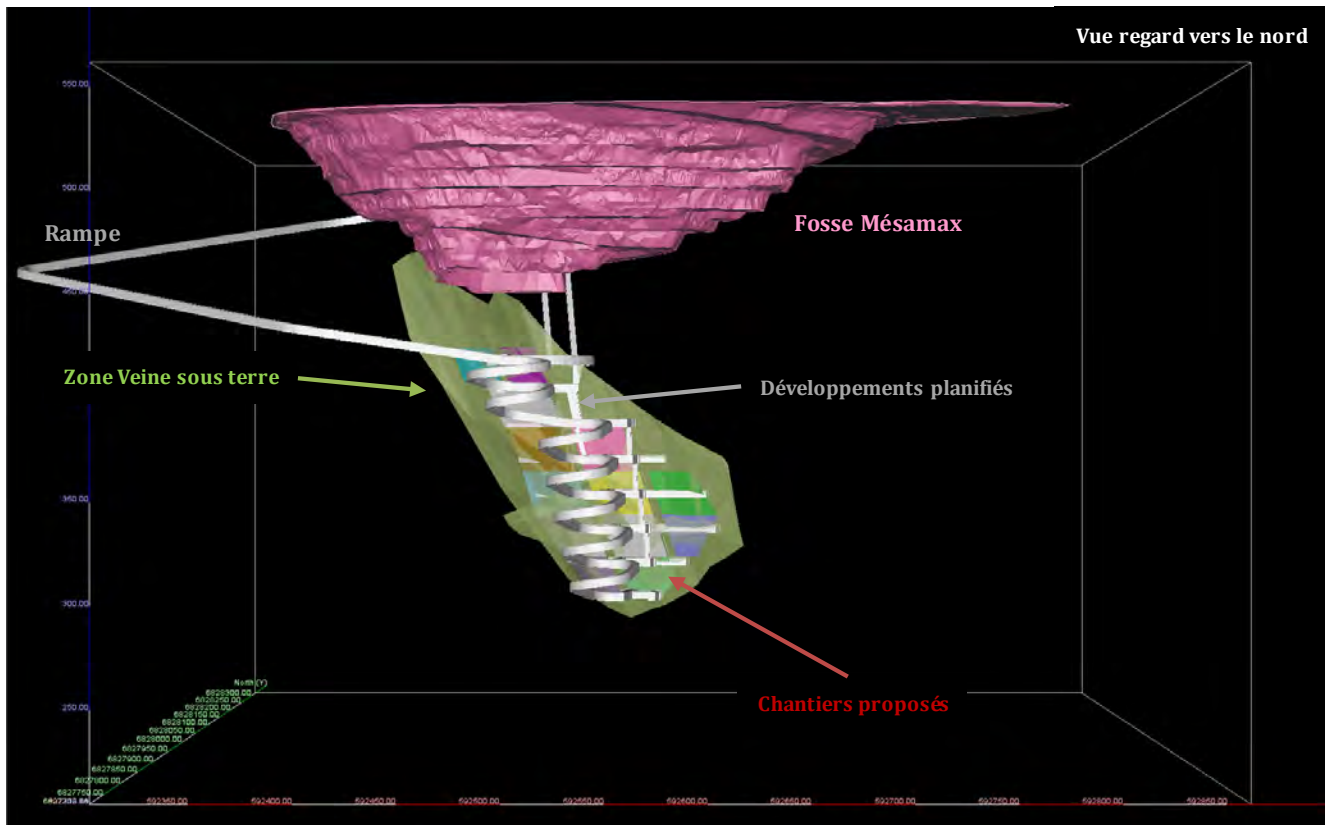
Vue avec regard vers le nord (rampe et chantiers planifiés pour la mine souterraine)
